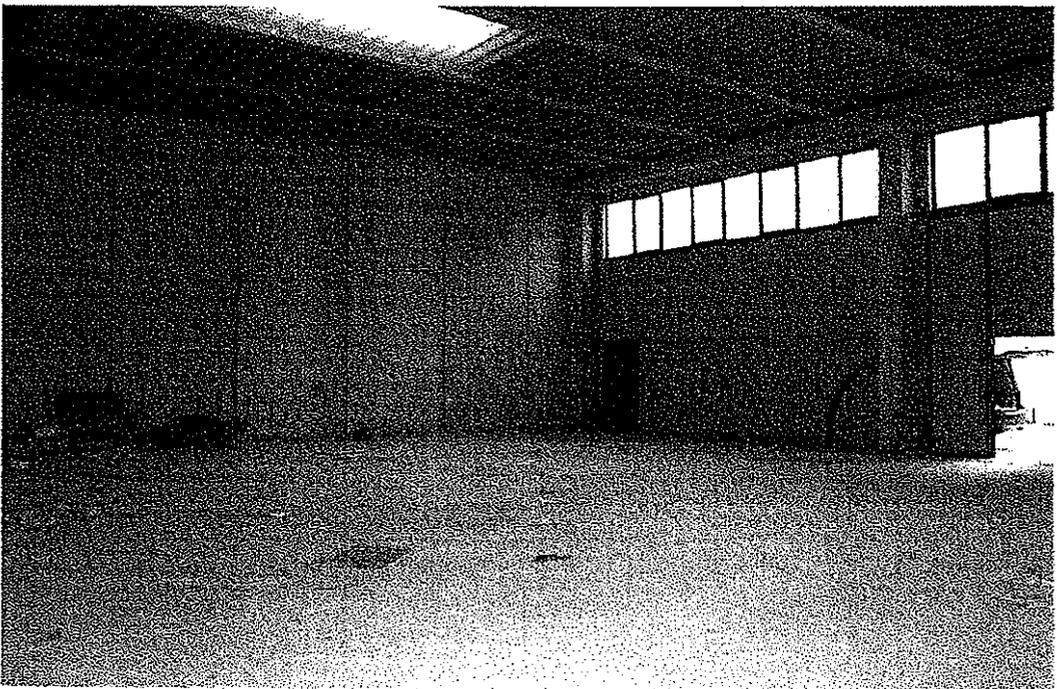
Vista interno laboratorio - Particella 914 sub 3
